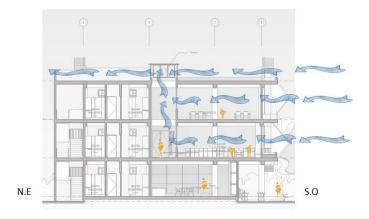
Ventilación en la zona de las salas de lecturas del proyecto. Fuente: Elaboración propia.
